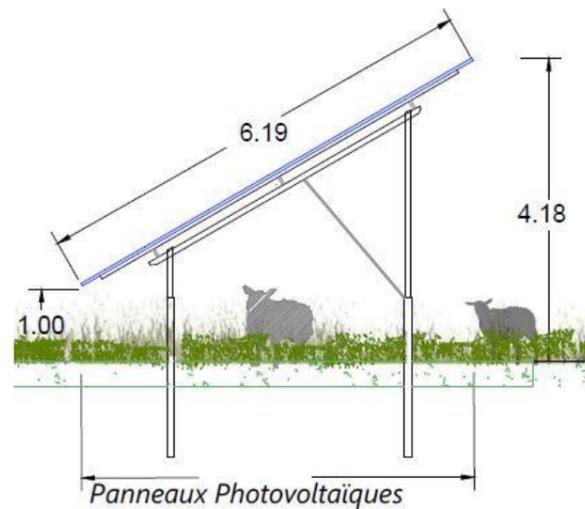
PLANS DE COUPE ET FAÇADES DES TABLES PHOTOVOLTAÏQUES
